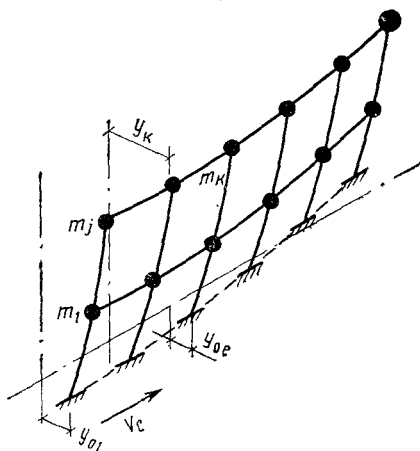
Расчетная схема здания, протяженно-го в плане
